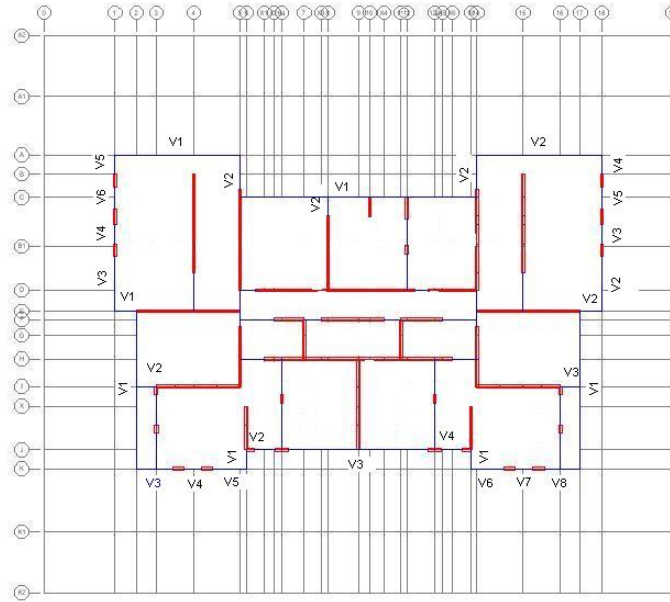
Numeración de vigas en Piso 2 a 20 – Edificio de Muros
